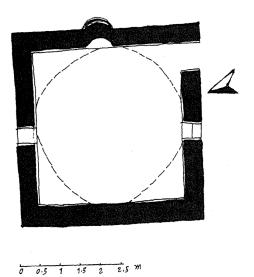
جامع الشيخ نصر الدين - مسقط أفقى
